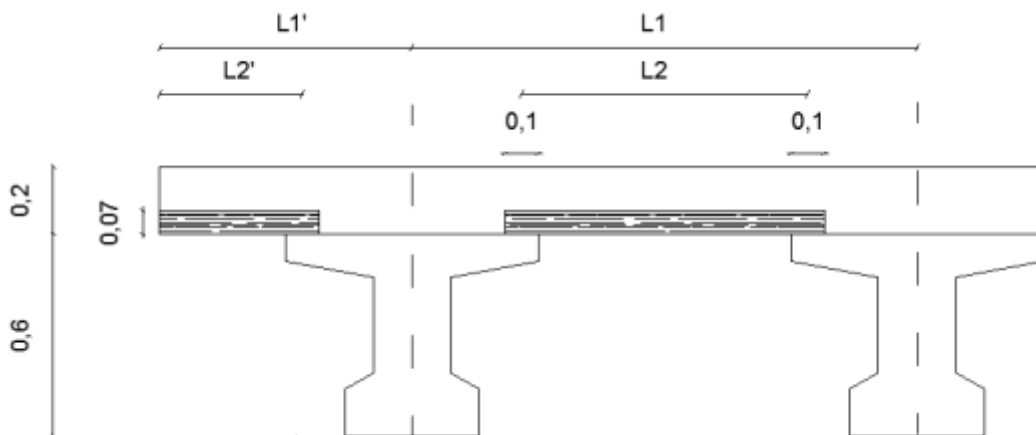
Esquema representativo da pré-laje apoiada nas vigas
